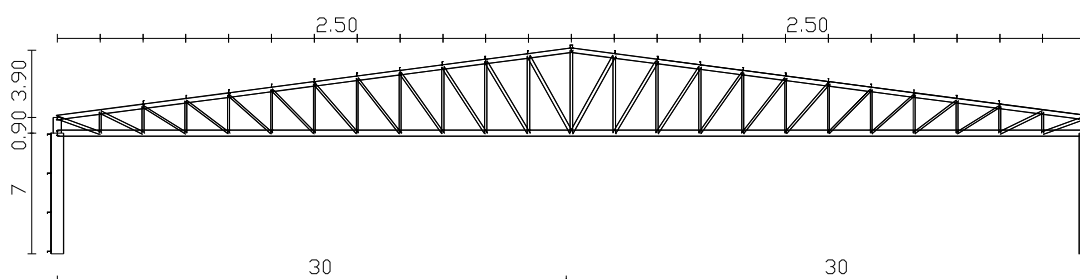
Pórtico com pilar de alma cheia, viga em treliça, vão de 60.00m
